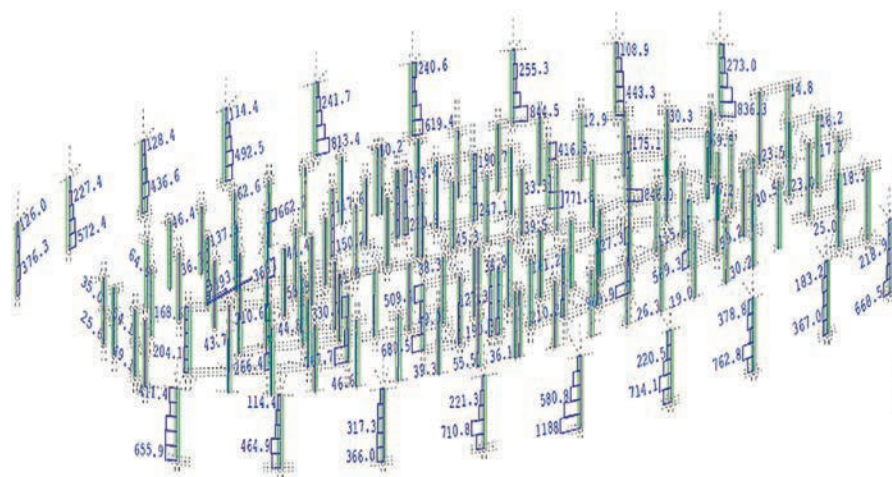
Esfuerzos cortantes longitudinales (kN) debidos a la acción sísmica. Pilares planta 0.
